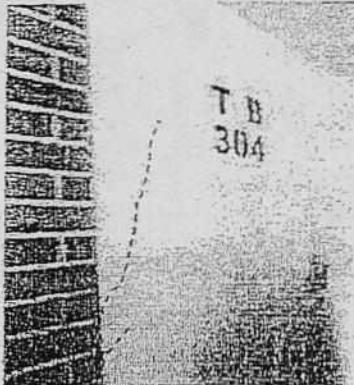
Fisura en muros de cerramiento-torre costado norte.
